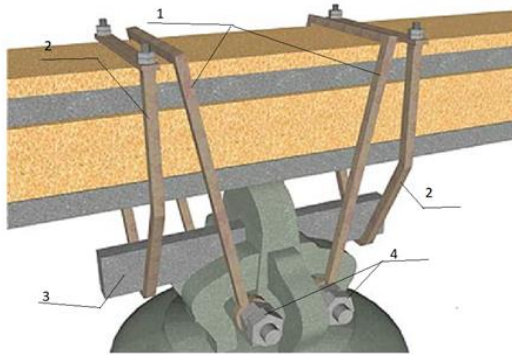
Схема балочної системи кріплення: 1 – основні хомути; 2 – додатковий хомут; 3 – металева пластина; 4 – болти кріплення
